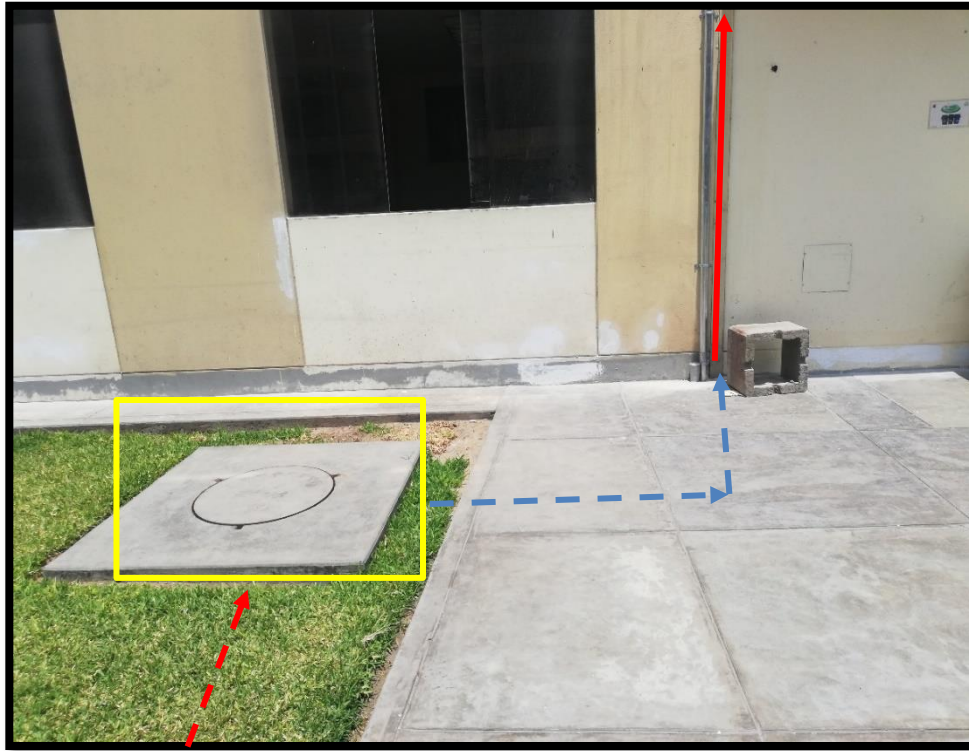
Fibra óptica llegó a buzón número 8 por canalizado existente y subió por tubería Conduit adosada a la pared por el pabellón B de la universidad
